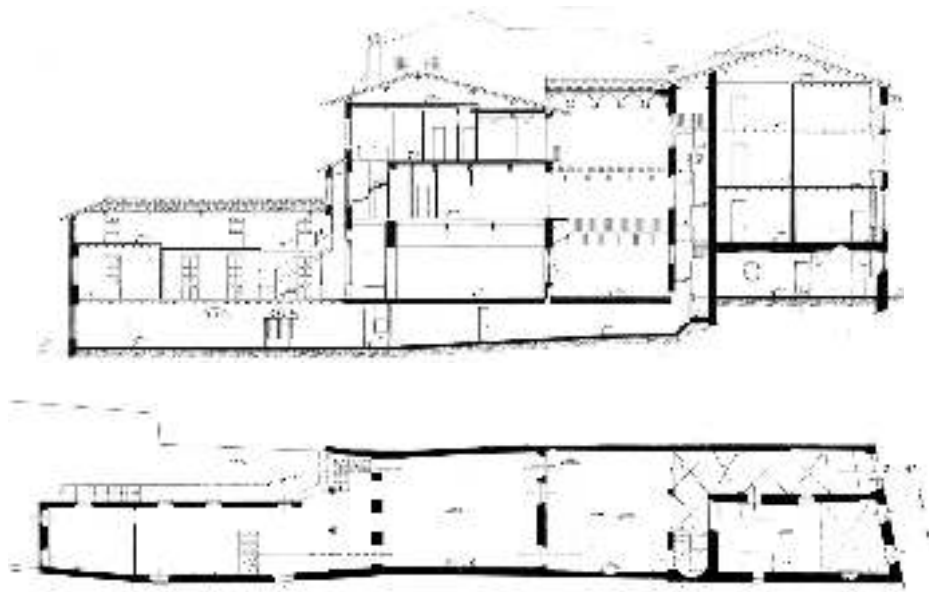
e 2. Palazzo Alessandri, sezione longitudinale e pianta pianoterra. Rilievo Studio ing. Moser, rielaborazione dell'autore.
